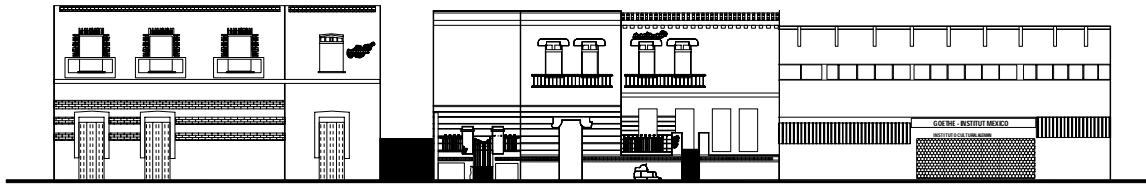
Perfil urbano de la calle de Tonalá entre Colima y Durango
